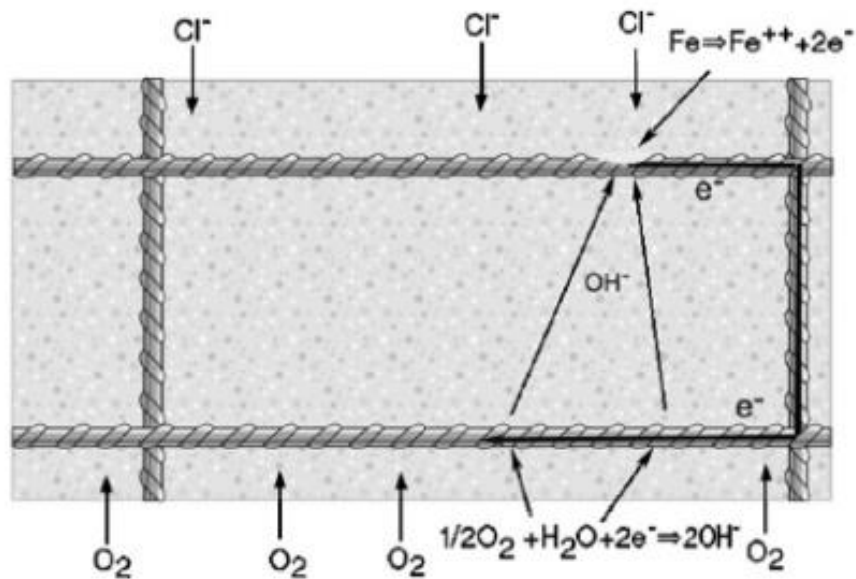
Macrocélula de corrosão em uma estrutura de concreto armado. (HANSSON, et al.,2006)
